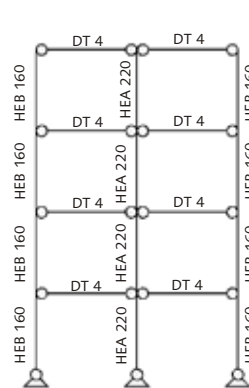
Grundriss Gelenk I - Haus 2
